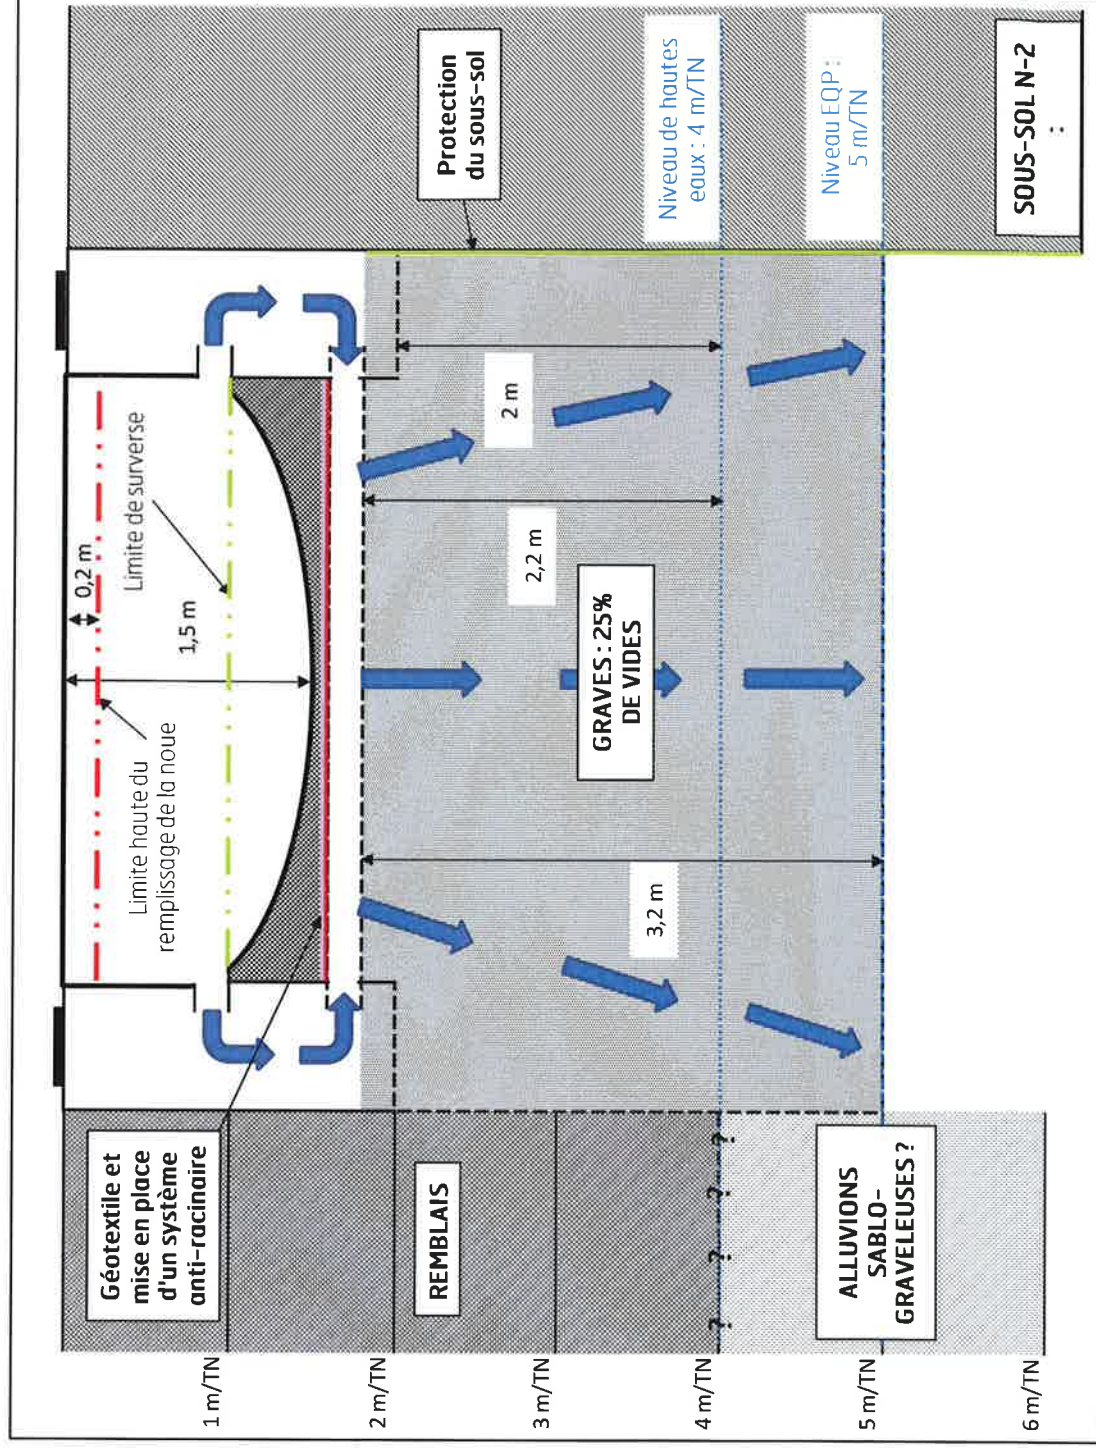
Plan d'implantation et coupe de principe des noues l'infiltration
